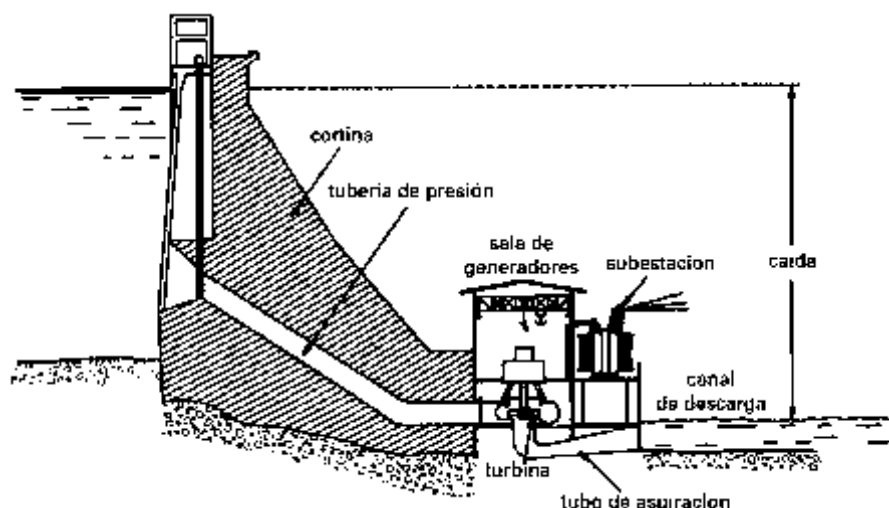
Vista de corte transversal de una planta hidroeléctrica
